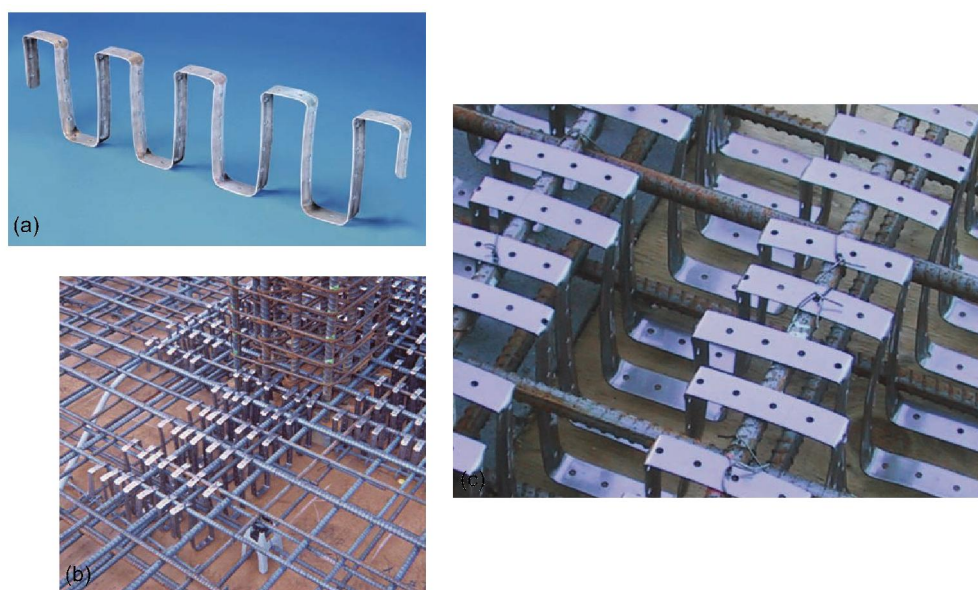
Sistema de armaduras de punçoamento "LENTON® STEEL FORTRESS": (a) Elemento "Lenton Steel Fortress" típico; (b) Colocação em obra; (c) Pormenor da ancoragem na armadura de flexão.
